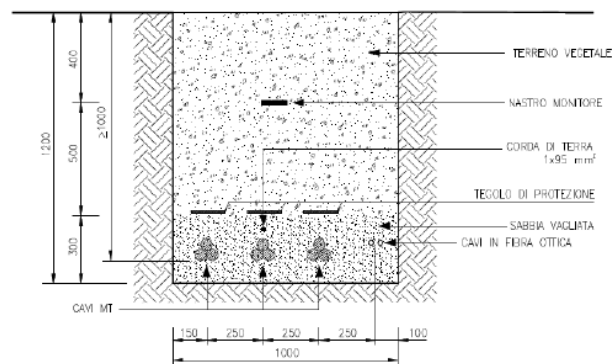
Sezione di posa cavidotti su terreno vegetale
